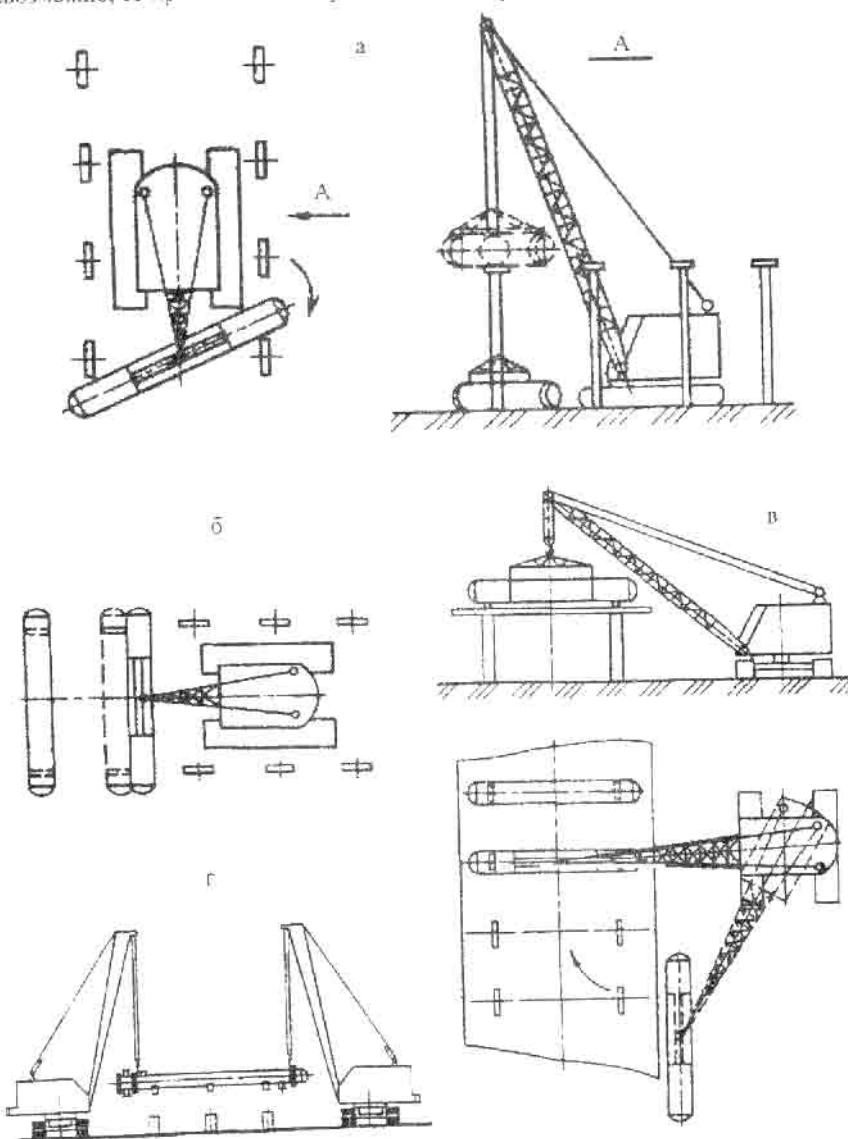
Схемы монтажа теплообменных аппаратов на открытой площадке
